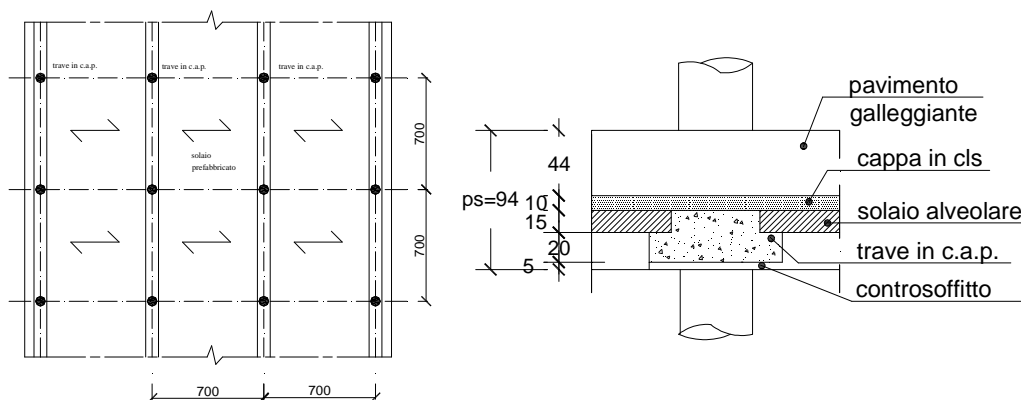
soluzione n.°2 in NSC, pianta di piano e sezione impalcato
